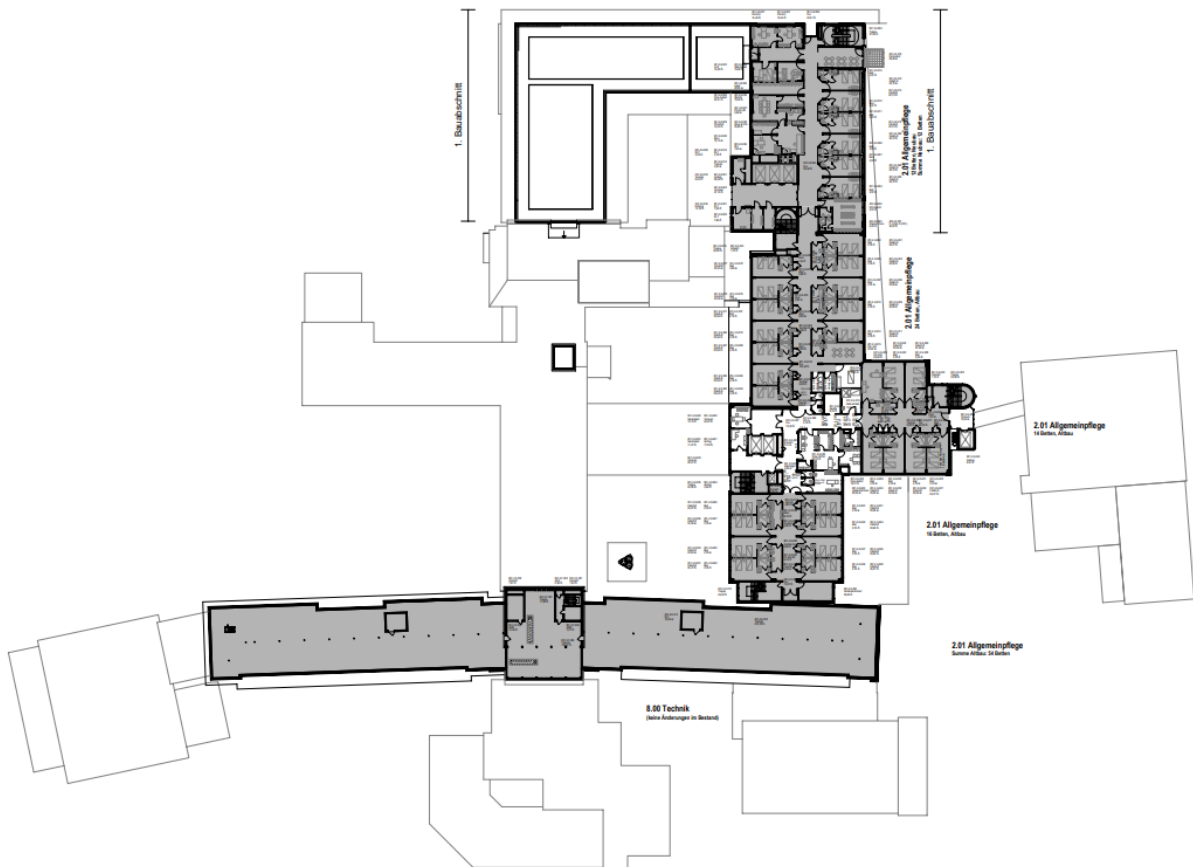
Grundriss 5. Obergeschoss mit Brandschutzmängeln (grau)
